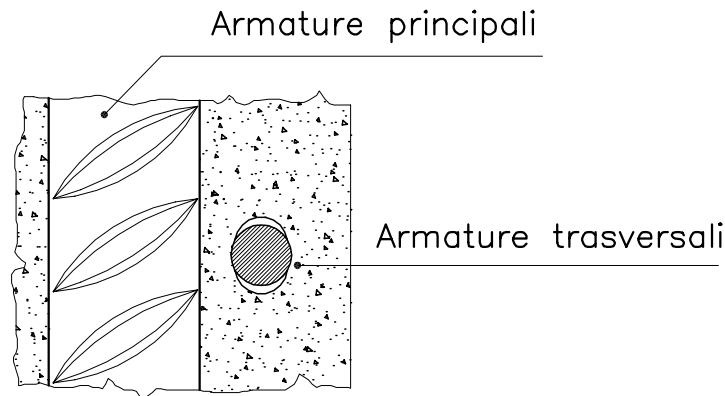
Disposizione delle nervature delle armature trasversali.
